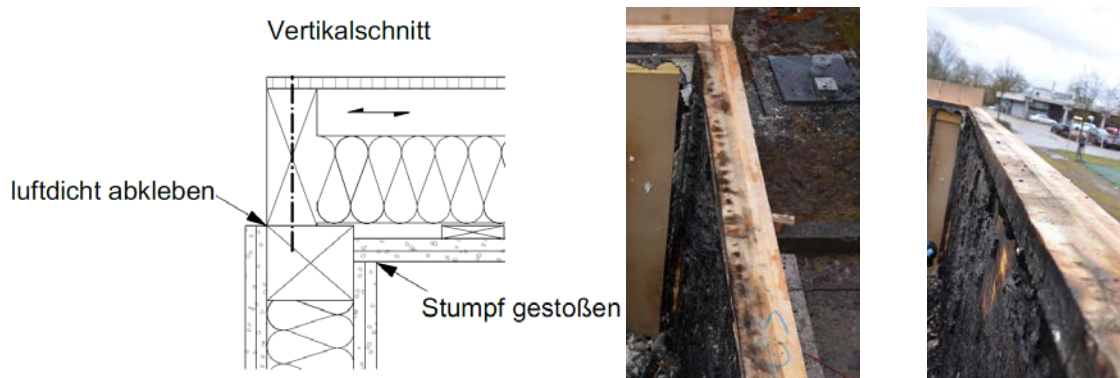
V2 – Bauteilanschluss – Decke - Wand 4
